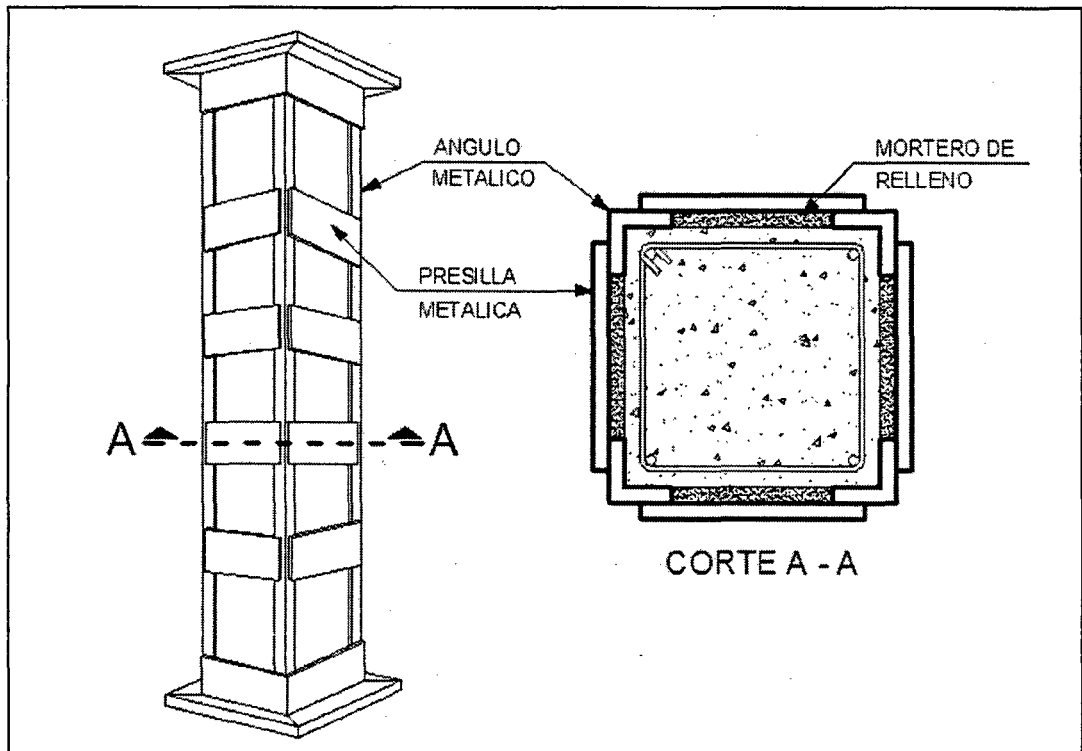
Refuerzo mediante angulares metálicos empresillados.
